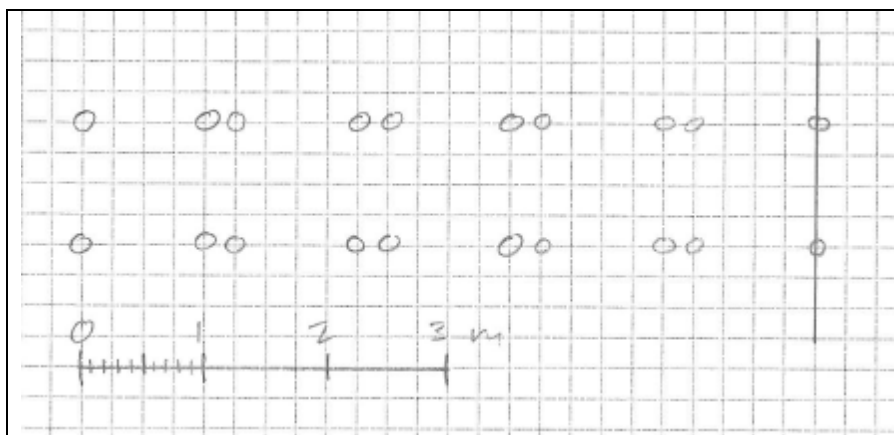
Plan över betonggolvet med inritade sågade fogar. Mått i m.
